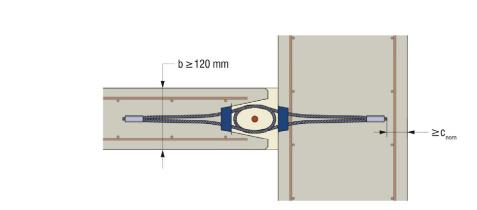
Wand – Wand – T-Verbindung - Regeldetail (planer Einbau)
